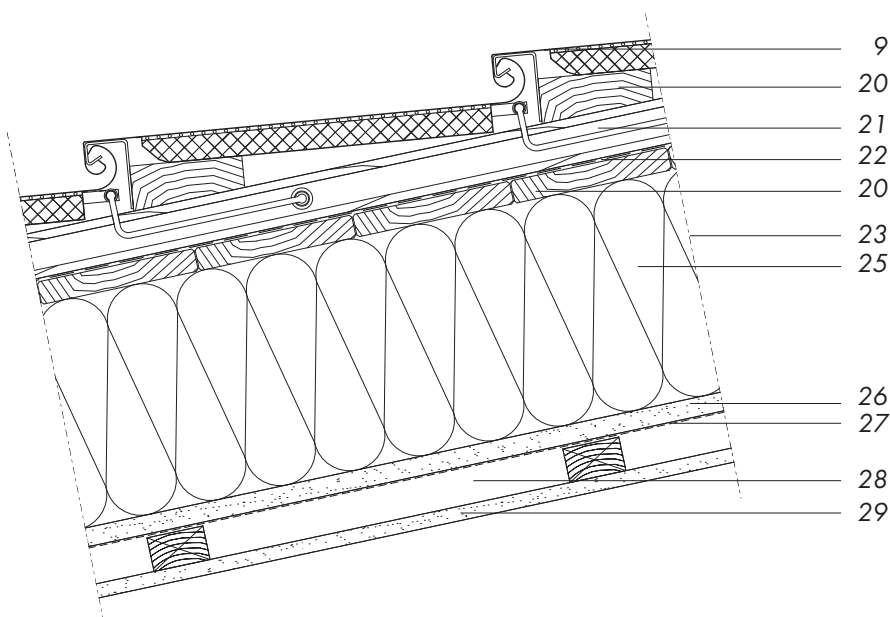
Konstruktionsbeschreibung Dachaufbau
